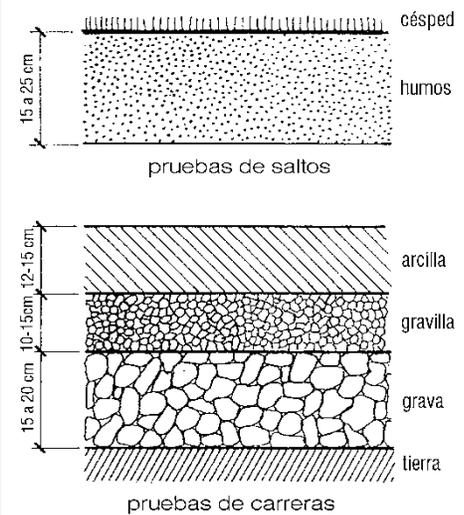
Pavimentación. Fuente: De Cusa, J. Instalaciones Deportivas.
